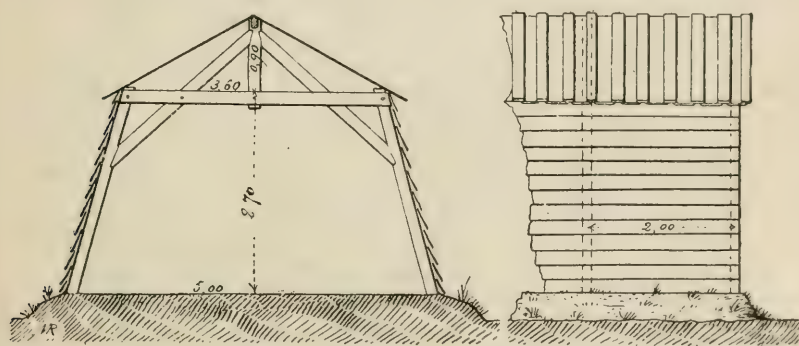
Baraquement en planches (coupe transversale et vue en long).
